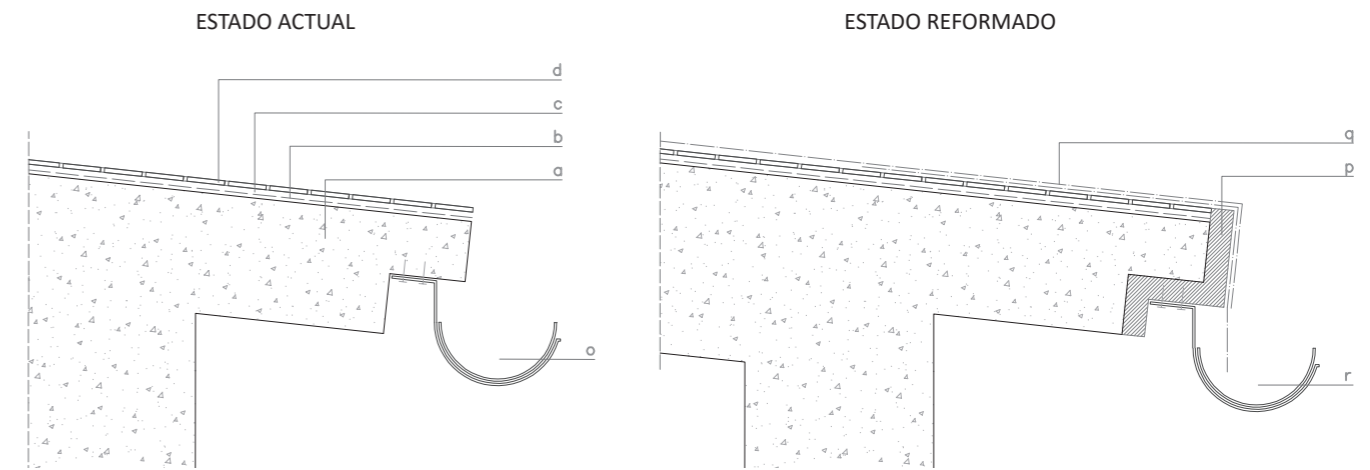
Detalle constructivo. Impermeabilización cubierta inclinada en encuentro con canalón. [Tabla 2]
